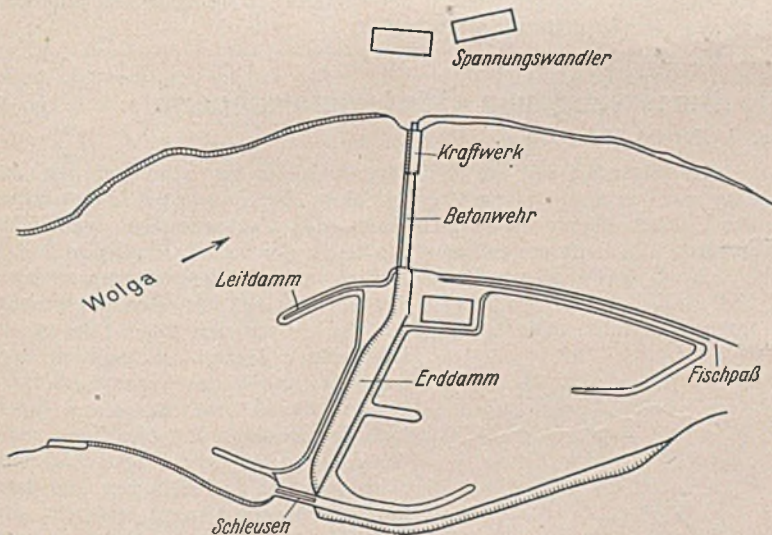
Shigulewsker Stauanlage, Lageplan.
